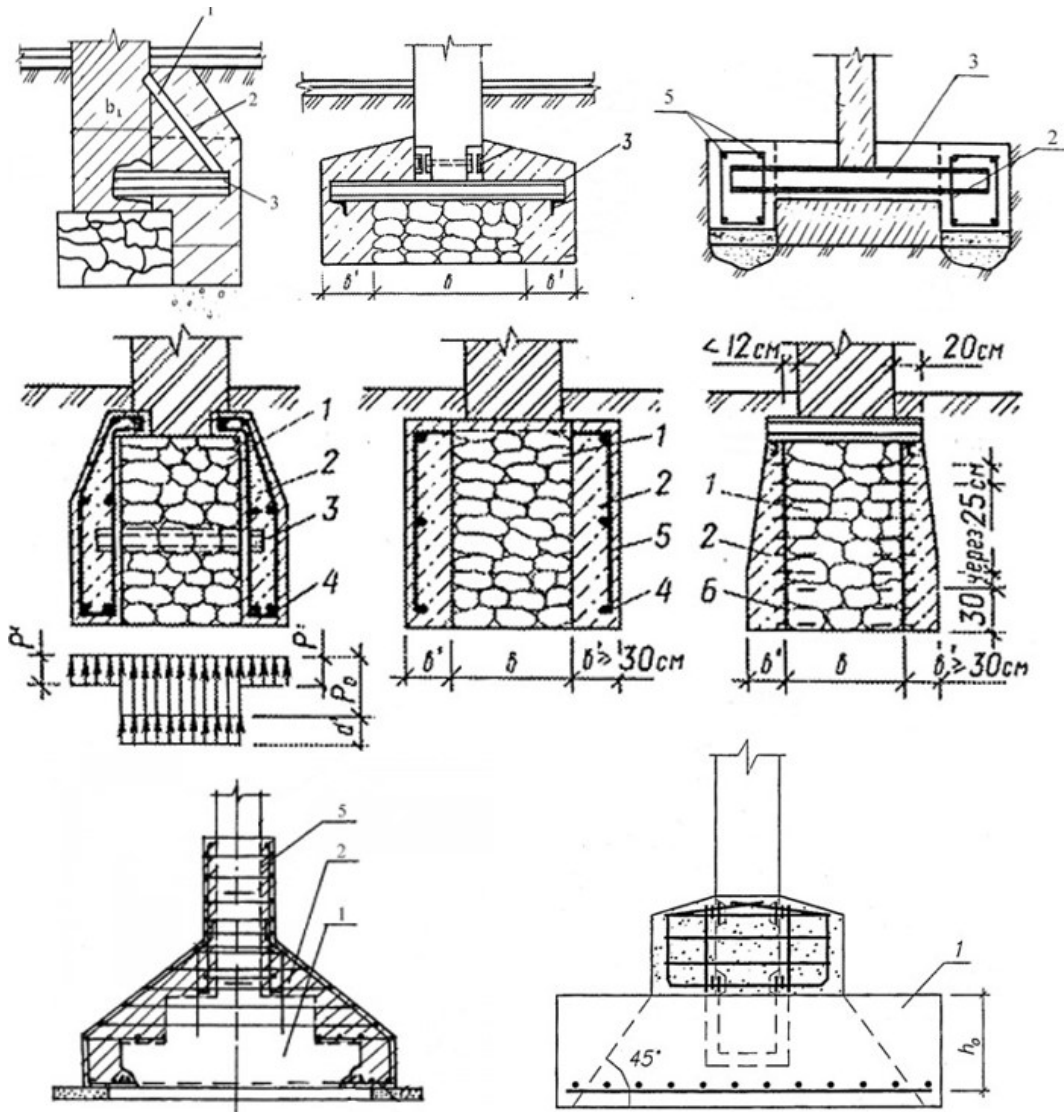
Примеры традиционных методов усиления фундаментов: 1 – существующий фундамент; 2 – обойма; 3 – распорка из металлических профилей; 4 – армирование обоймы; 5 – арматурный каркас; 6 – анкеры.
